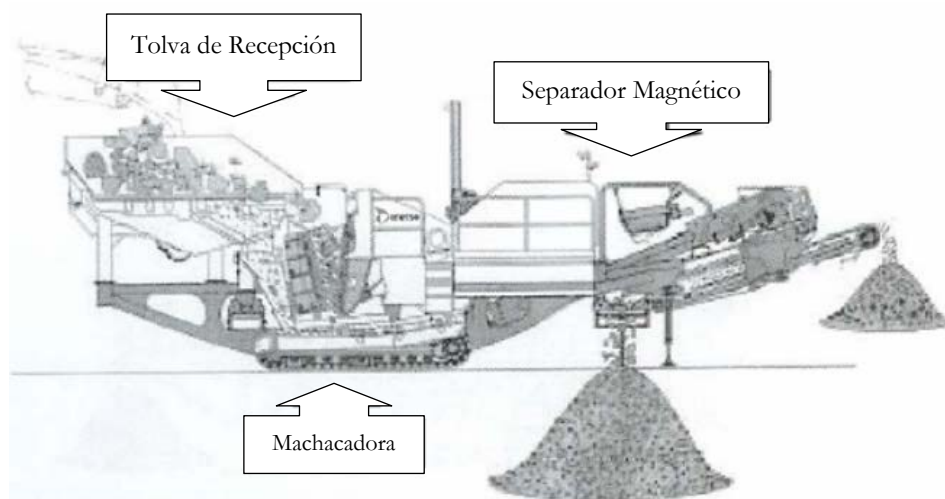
Planta móvil de reciclaje de RCDs. Fuente [3]
